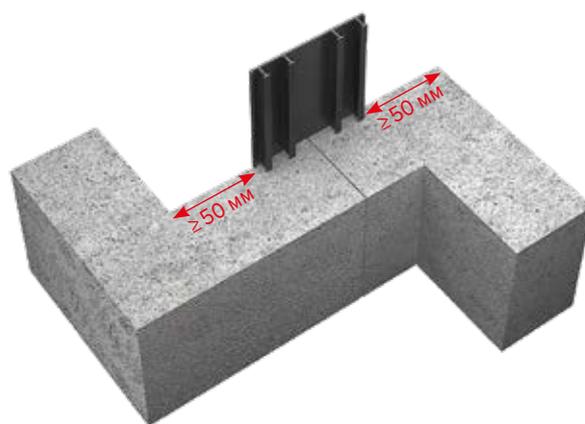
Расстояние от края наружных гидрошпонок до угла конструкций
